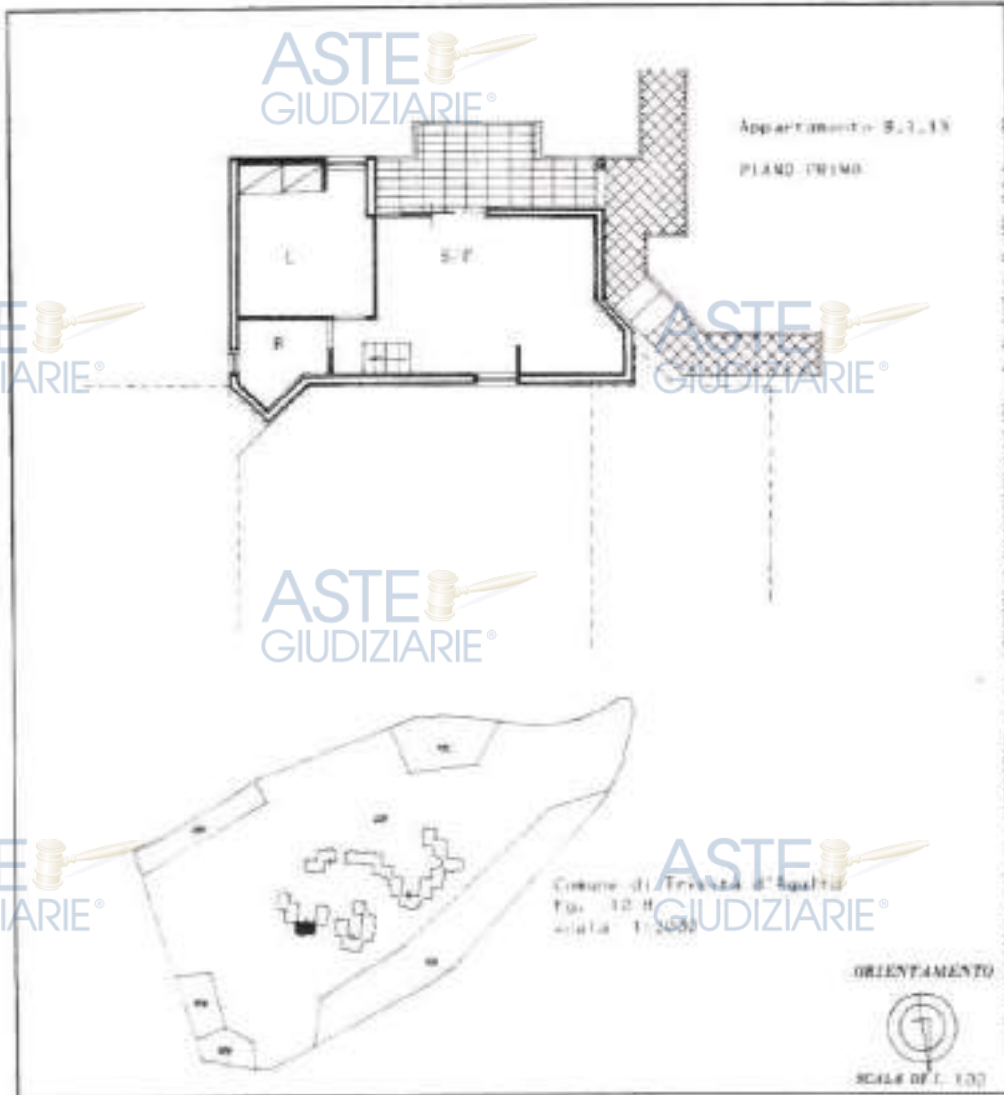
Visura planimetrica catastale aggiornata Fig. 10 Part. 429 Sub 18
